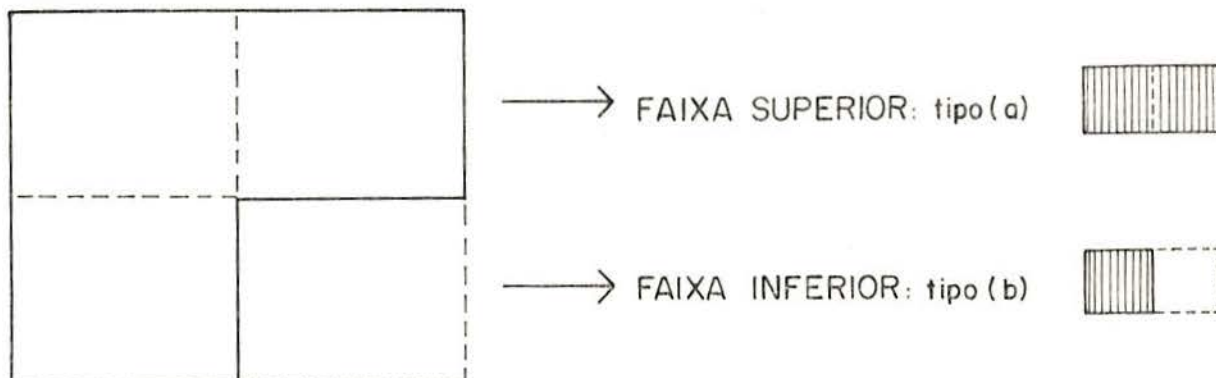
Representação da configuração da laje em "ELE" por faixas horizontais
